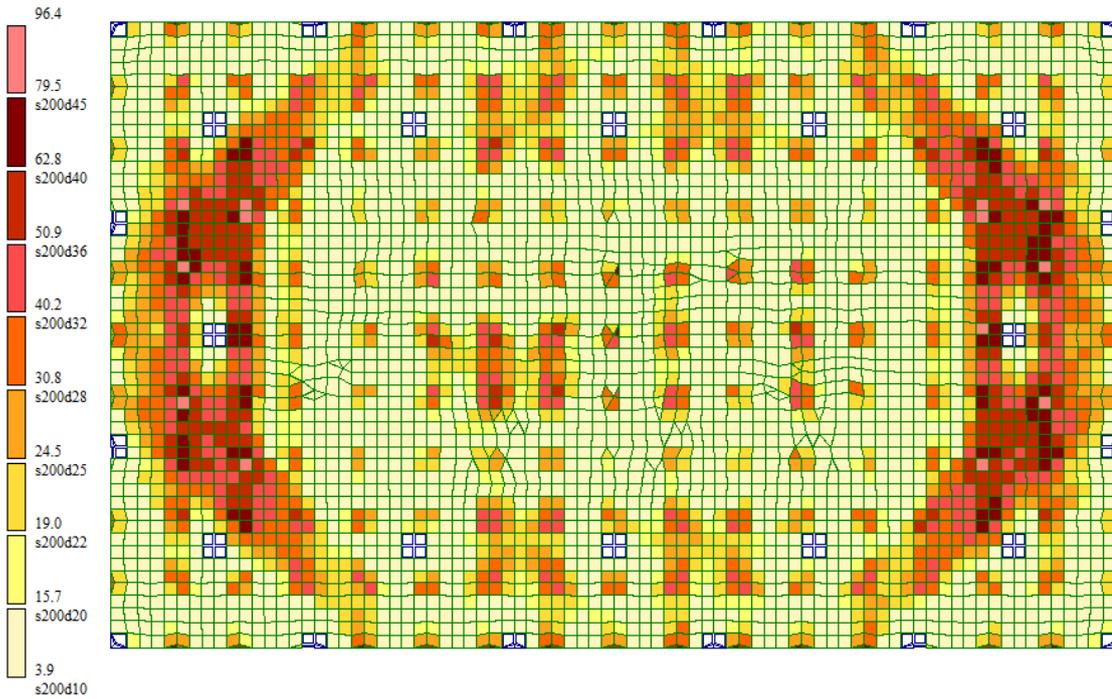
Схема армирования верха фундаментной плиты по оси OX
